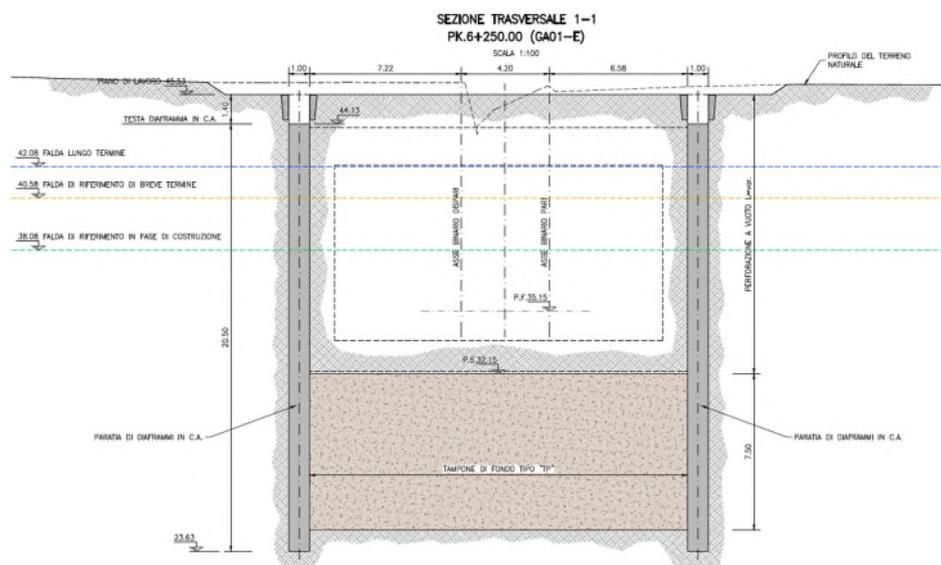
Sezione tipologica in corrispondenza della camera di arrivo del manufatto a spinta (monolite)
